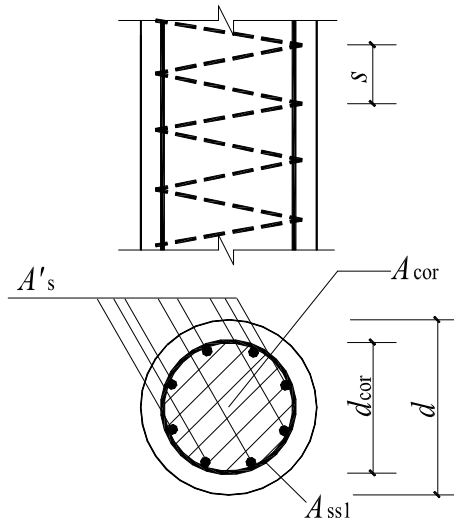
配置螺旋式间接钢筋的钢筋混凝土轴心受压构件截面
